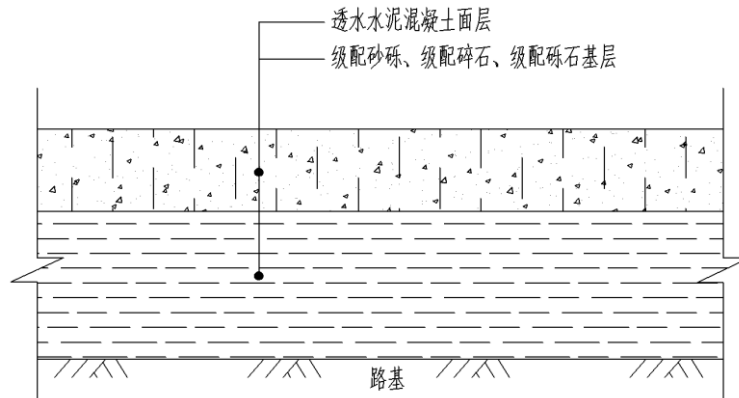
全透式透水水泥混凝土人行道路面结构示意图
